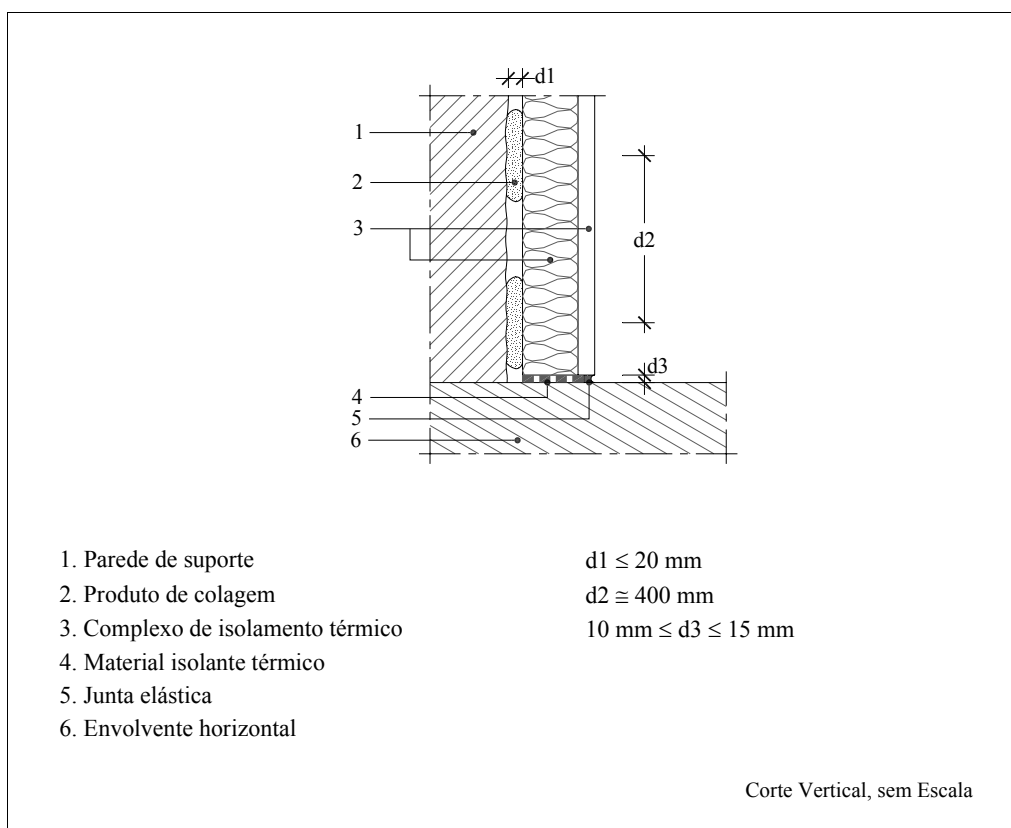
Pormenor de ligação de um sistema do tipo directo com um pavimento em zona corrente (não húmida)
